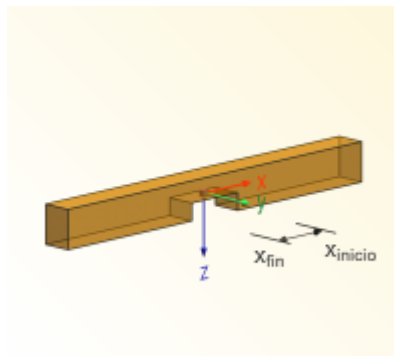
Ejemplo de cambio de sección o recorte en un elemento de madera.
